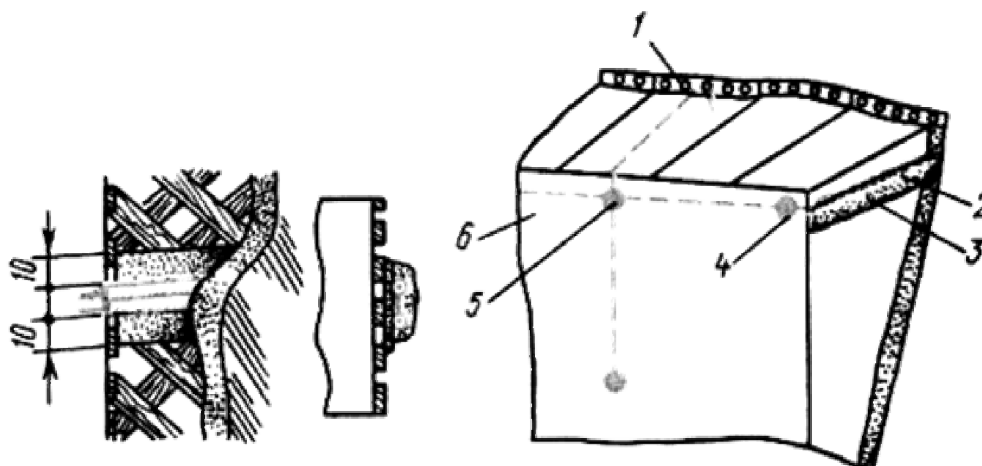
Скрытые электропроводки под сгораемыми основаниями и в пустотах строительных конструкций:
